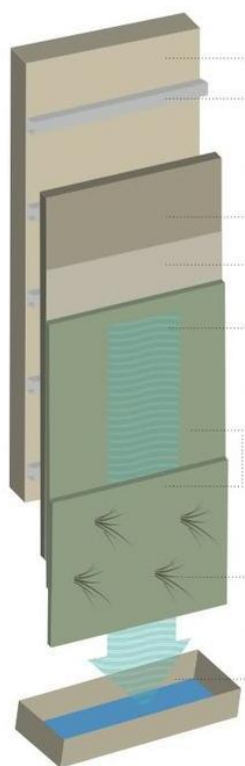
Вертикальное озеленение фасада здания по системе Бланка
